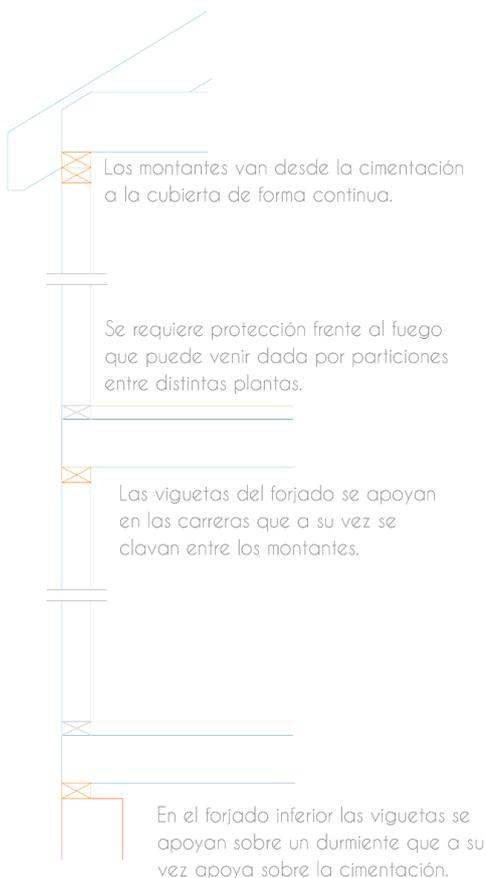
Sección constructiva sistema Balloon Frame. (Dibujo original)
